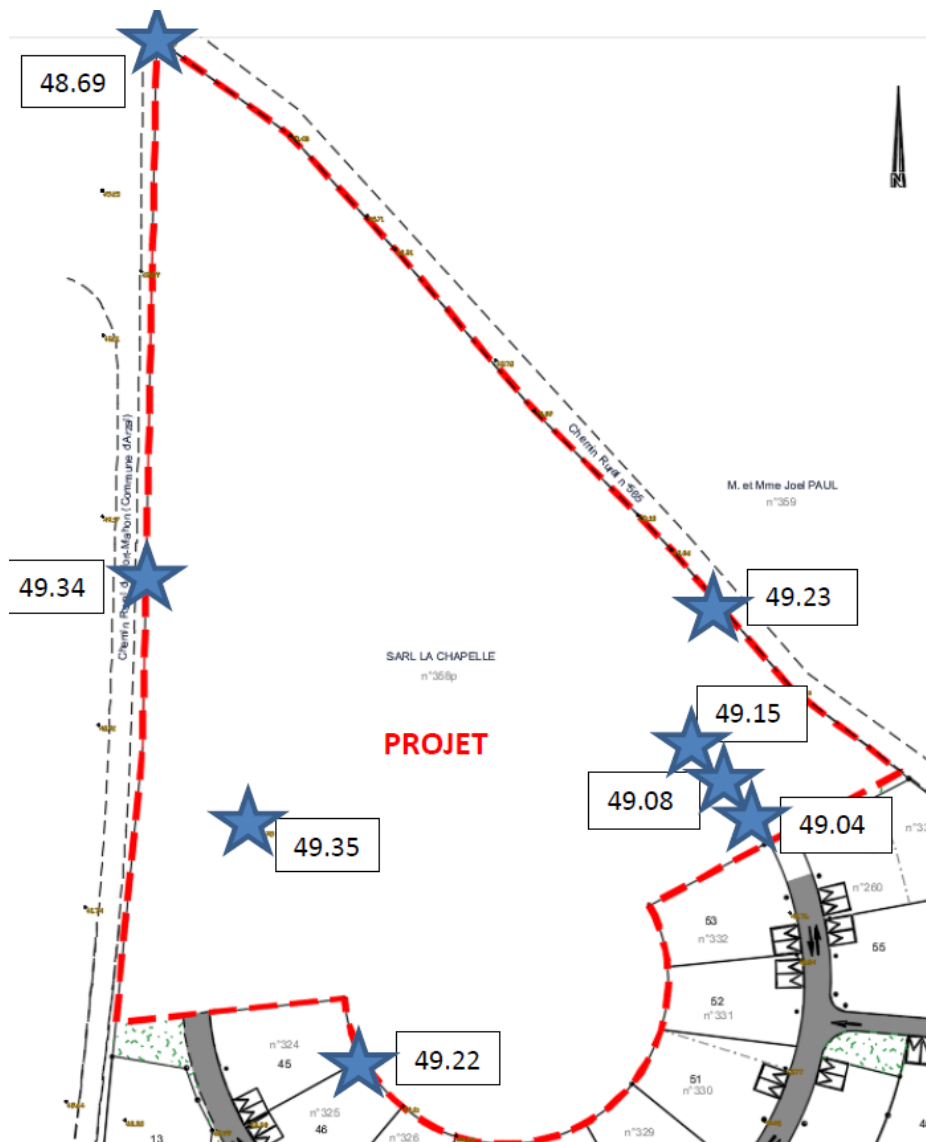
plan topographique du projet d'extension Nord (source : Premier plan, PA2, 2021)
